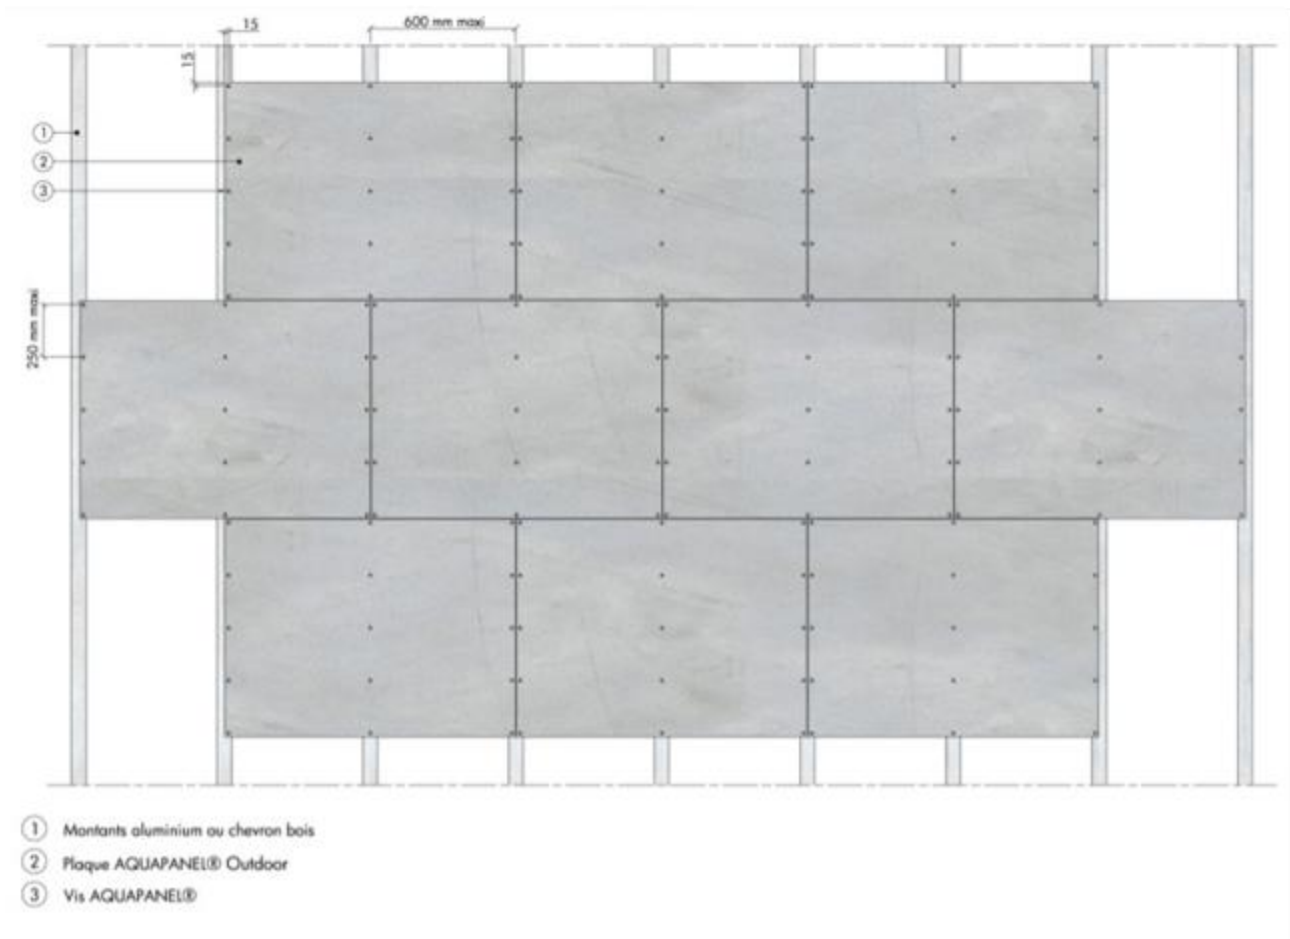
Calepinage des plaques et espacement des vis - pose horizontale
